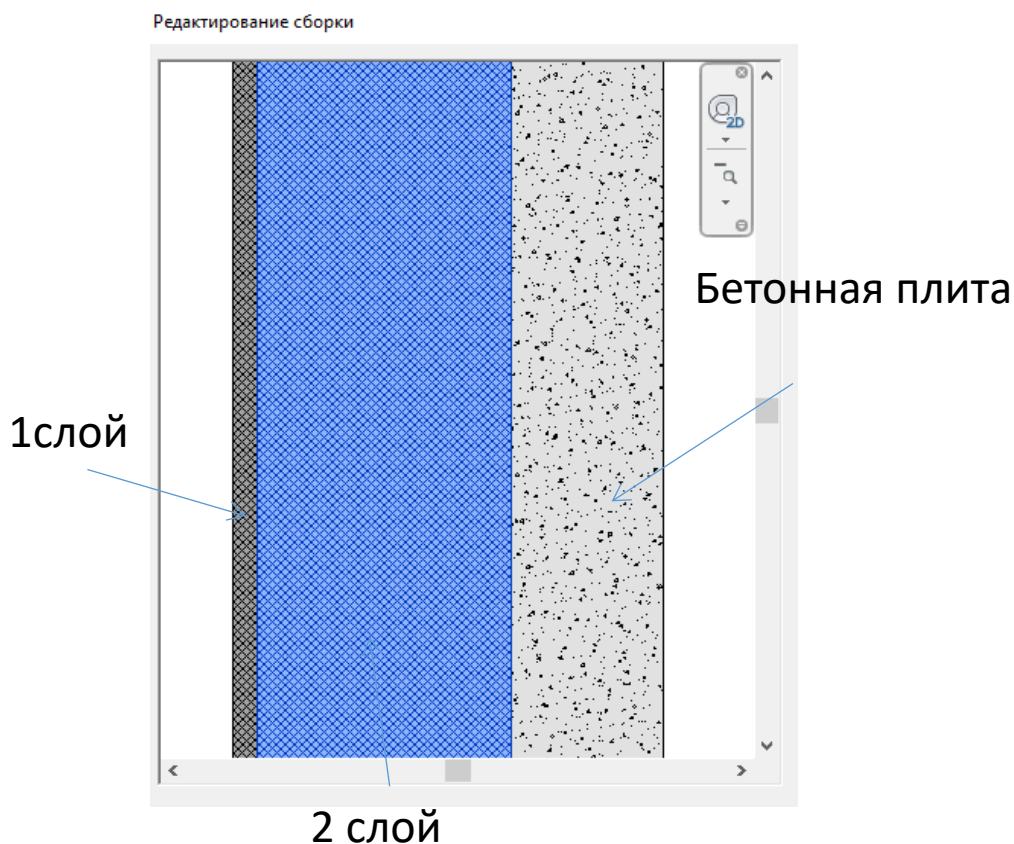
Сборка из теплоизоляционных слоев фасада здания.
